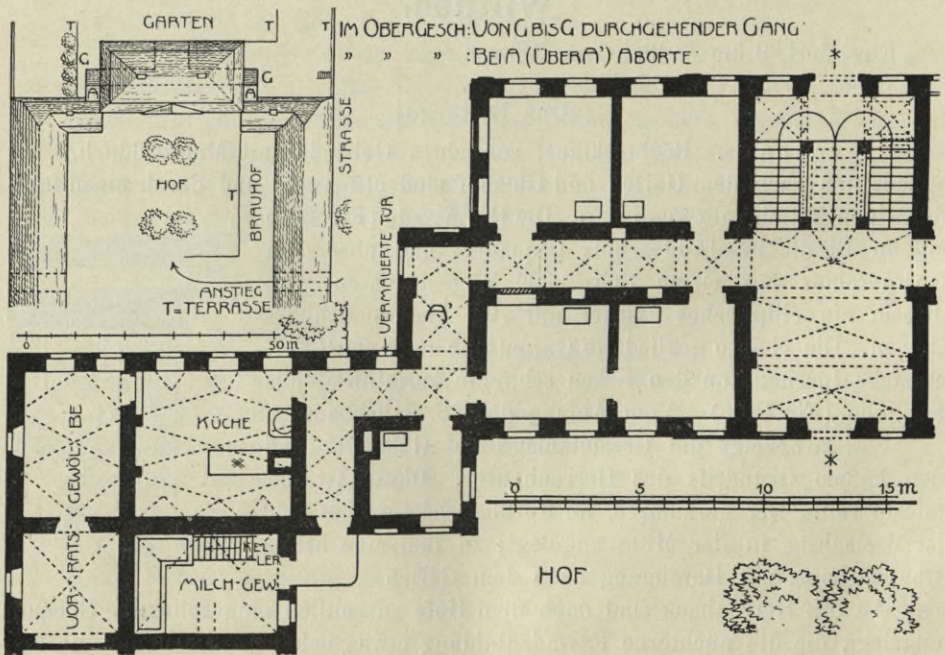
Wilthen, Herrenhaus, Lageplan und Hälfte des Erdgeschoß-Grundrisses.
